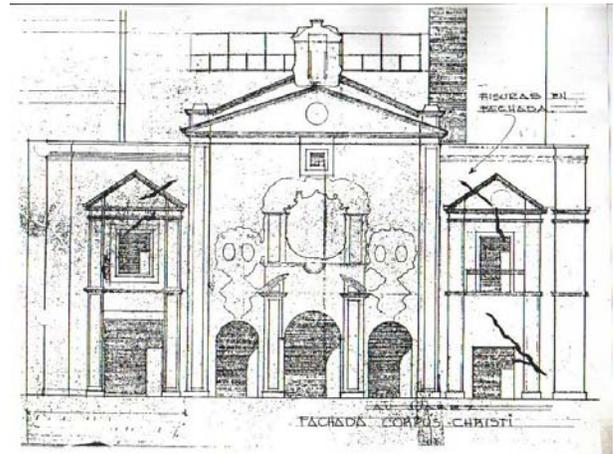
Fisuras en fachada norte. (Principal.)
